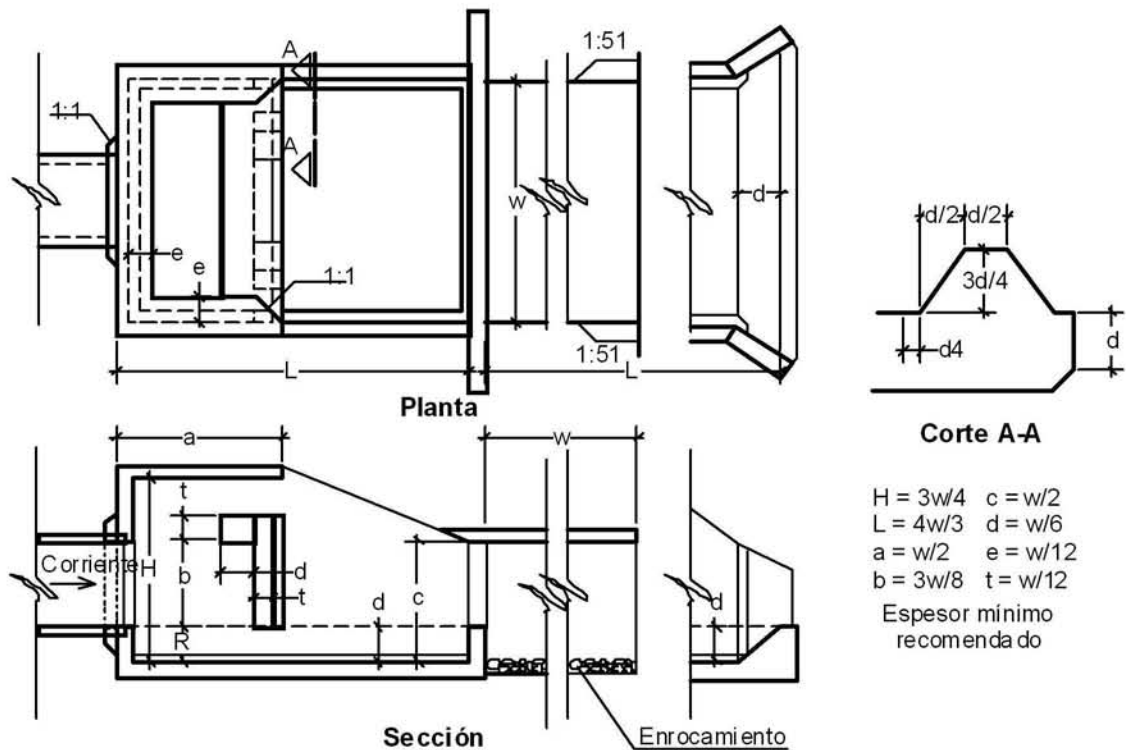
Configuración general de un proyecto de bloques de impacto
